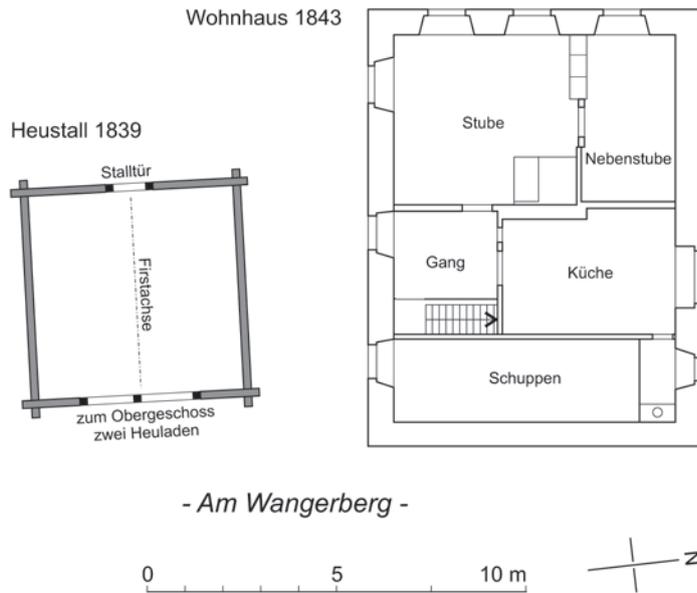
Wohnhaus und Heustall. Grundriss des Erdgeschosses. M. 1:200.
